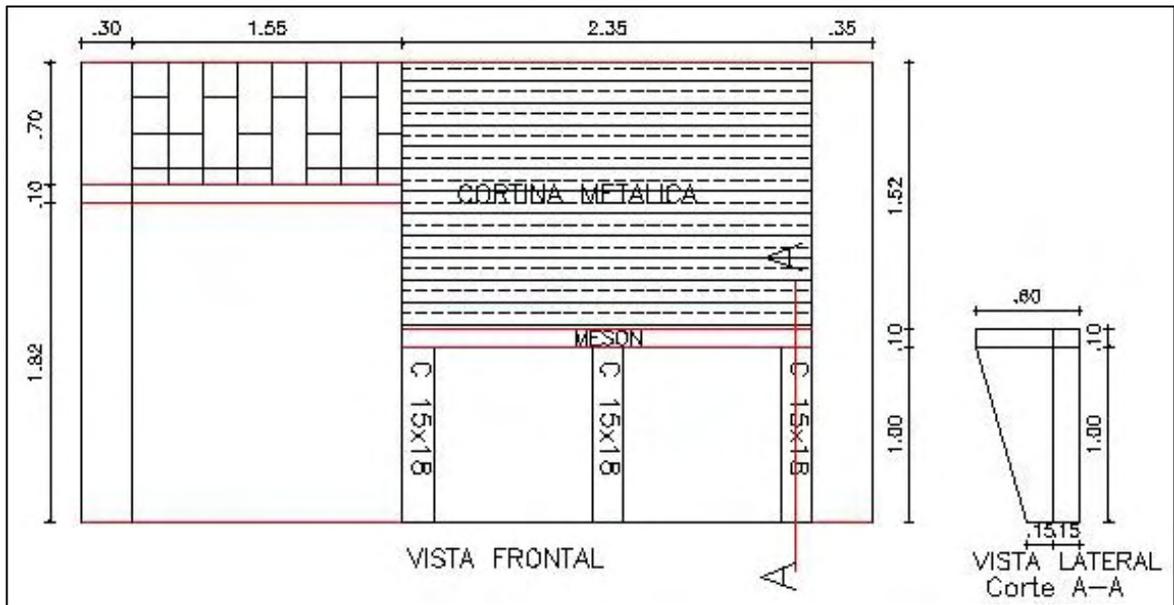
Propuesta de construcción de cortina metálica y mesón.
